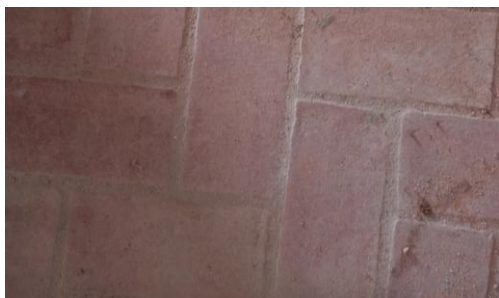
Pavimento existente em terracota_interior. Fonte: Atelier Studio Arte
